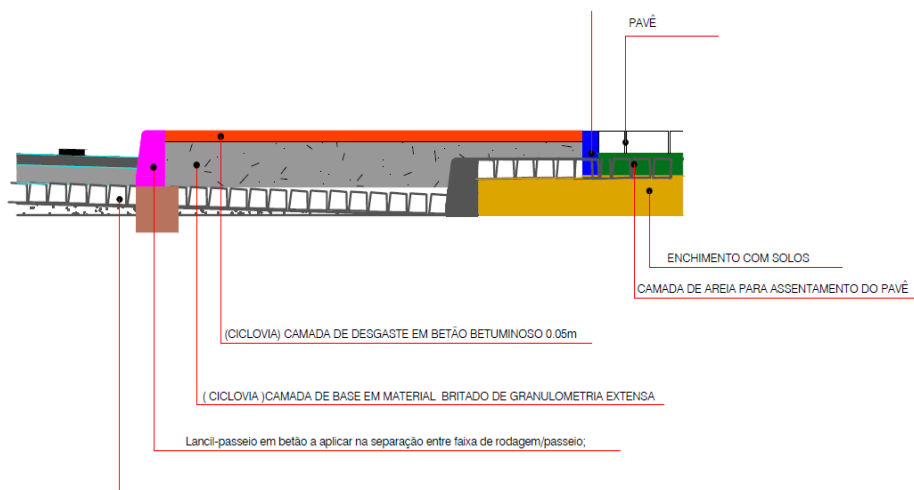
16: Pormenor construtivo em zona de passeio passeio [Instituto de Estradas de Cabo Verde, 2015]
